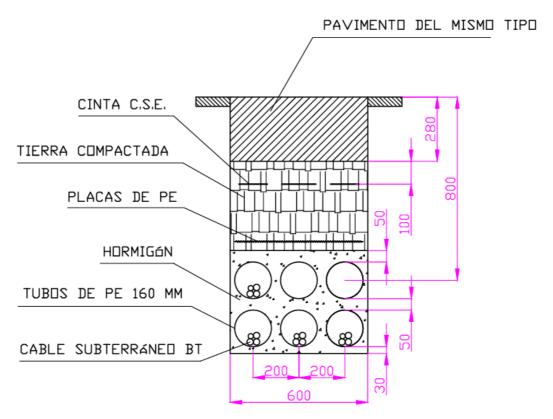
Zanja en asfalto, aparcamiento, hormigón, tierra y acerado.
